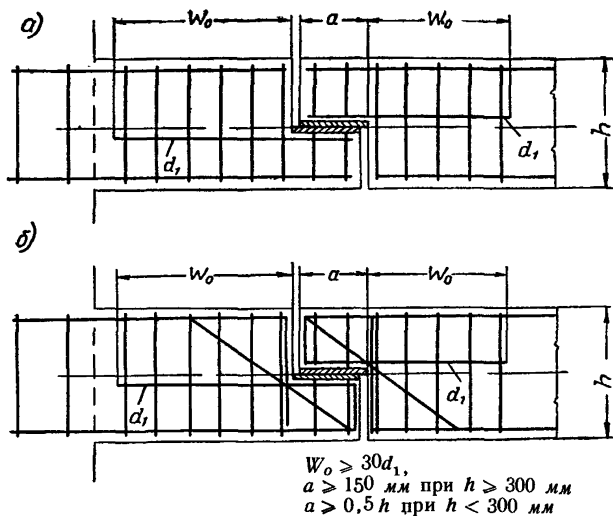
Армирование концов железобетонных балок с глубокими подрезками
